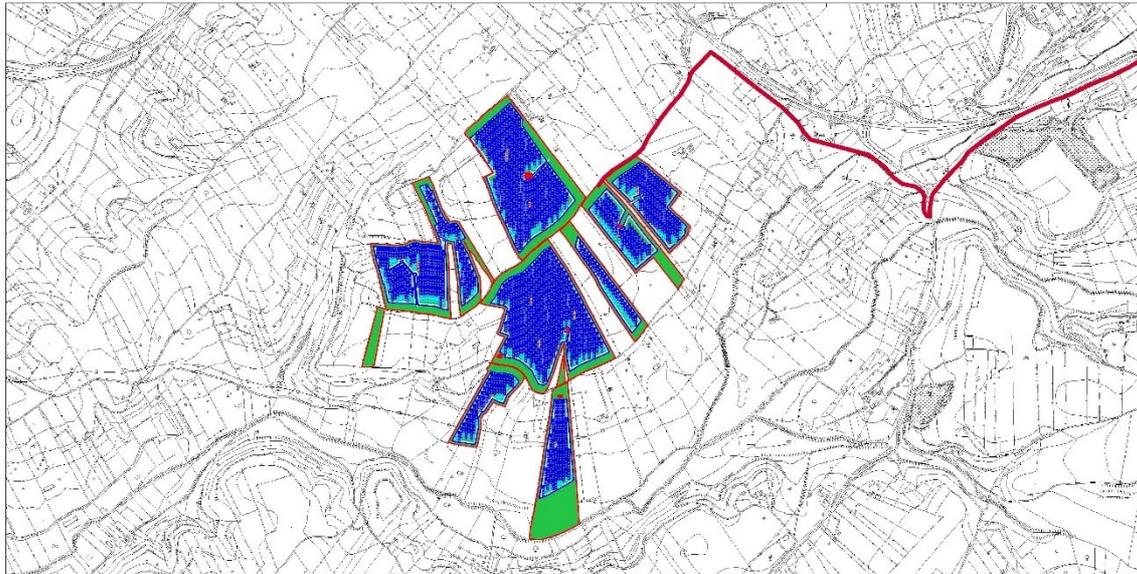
Layout dell'area d'impianto ricadente sul territorio di Caltagirone (CT) località Ramione con cavidotto
